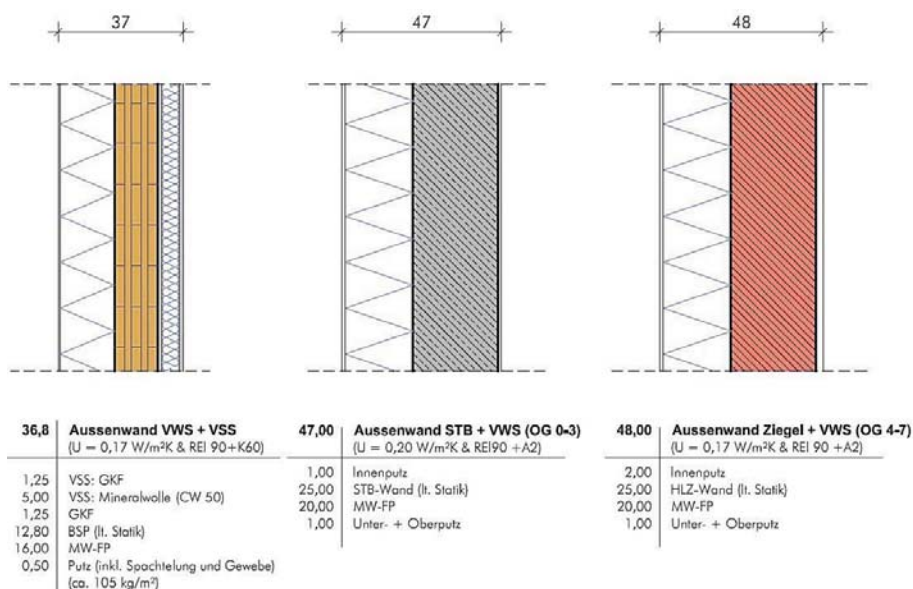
Vergleich der Außenwände des achtgeschossigen Wohnbaus
